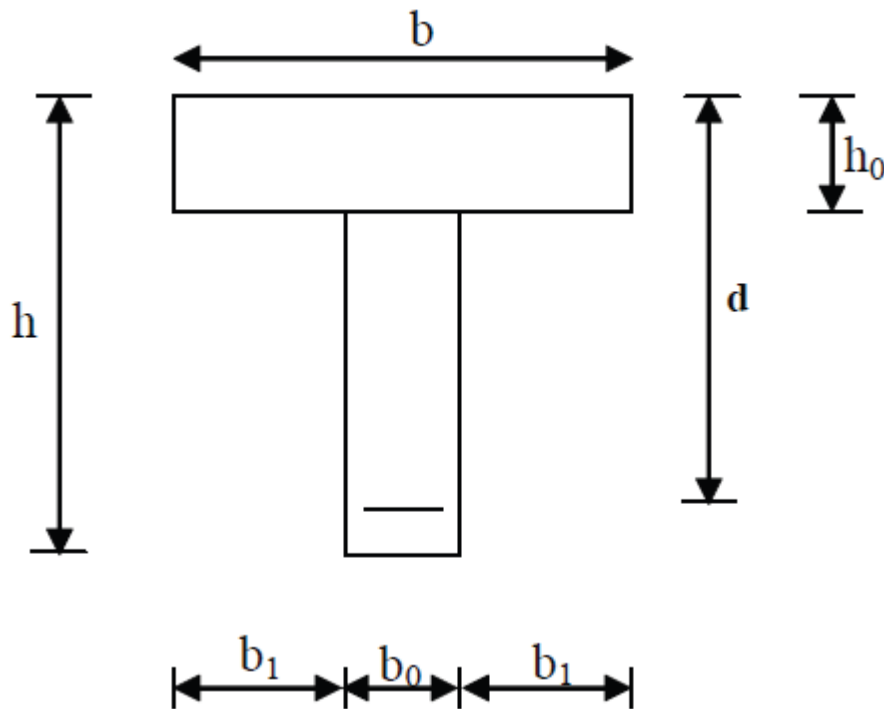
Schéma de calcul de la poutrelle après coulage de la dalle de compression en travées.
